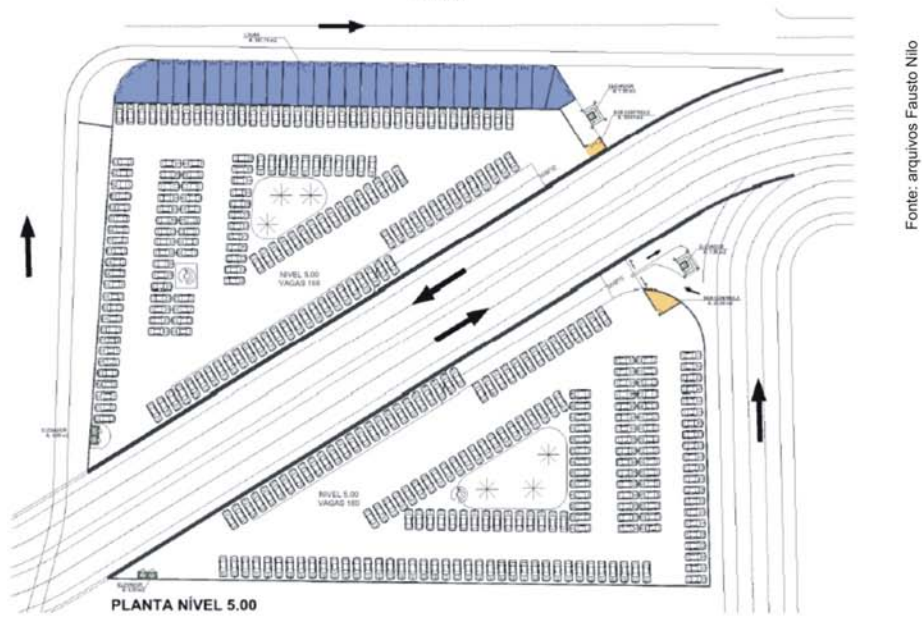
planta baixa do nível do estacionamento proposto onde passa a via subterrânea
